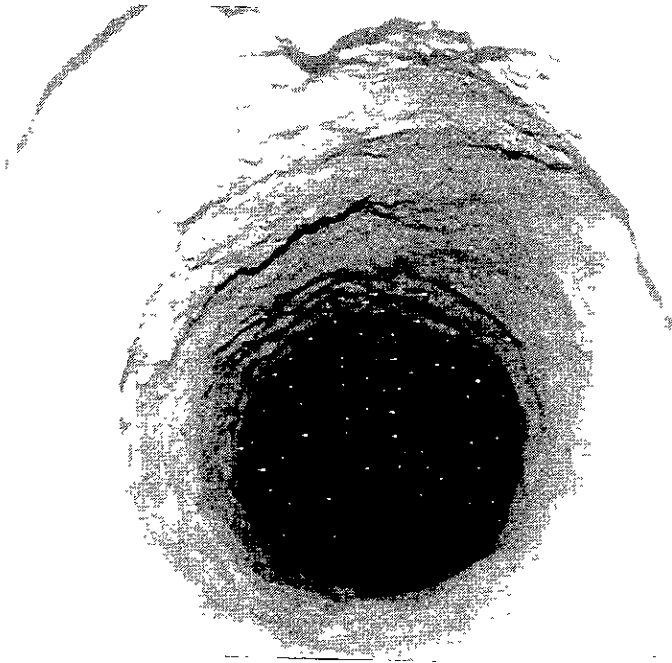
Paredes de la excavacion en la pila de 3 m de profundidad en el Sitio Point of Mountain West
